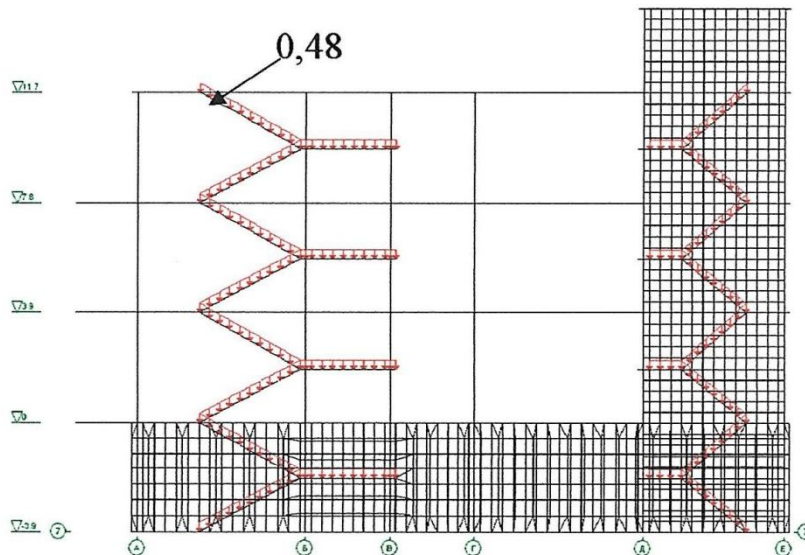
Схема завантаження 5 – тимчасове навантаження 3, навантаження на сходи і майданчики, т/м<sup>2</sup>
